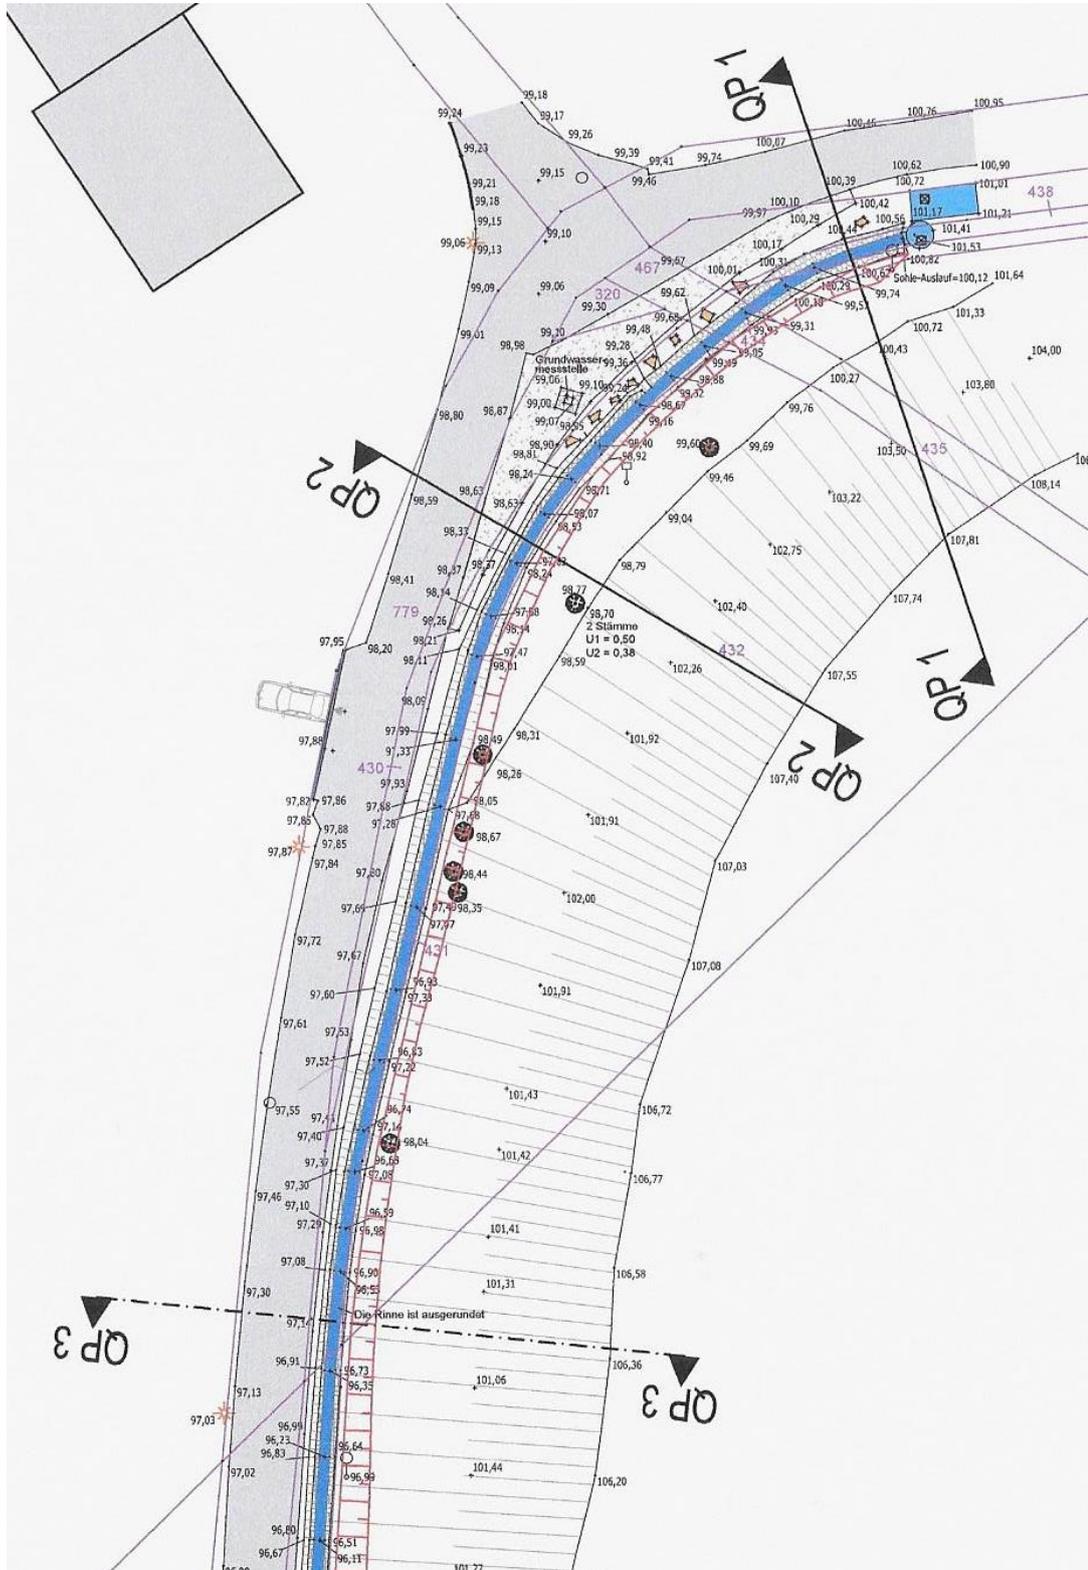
Vorhandenes Gerinne unterhalb der Verrohrung (Lageplan)
